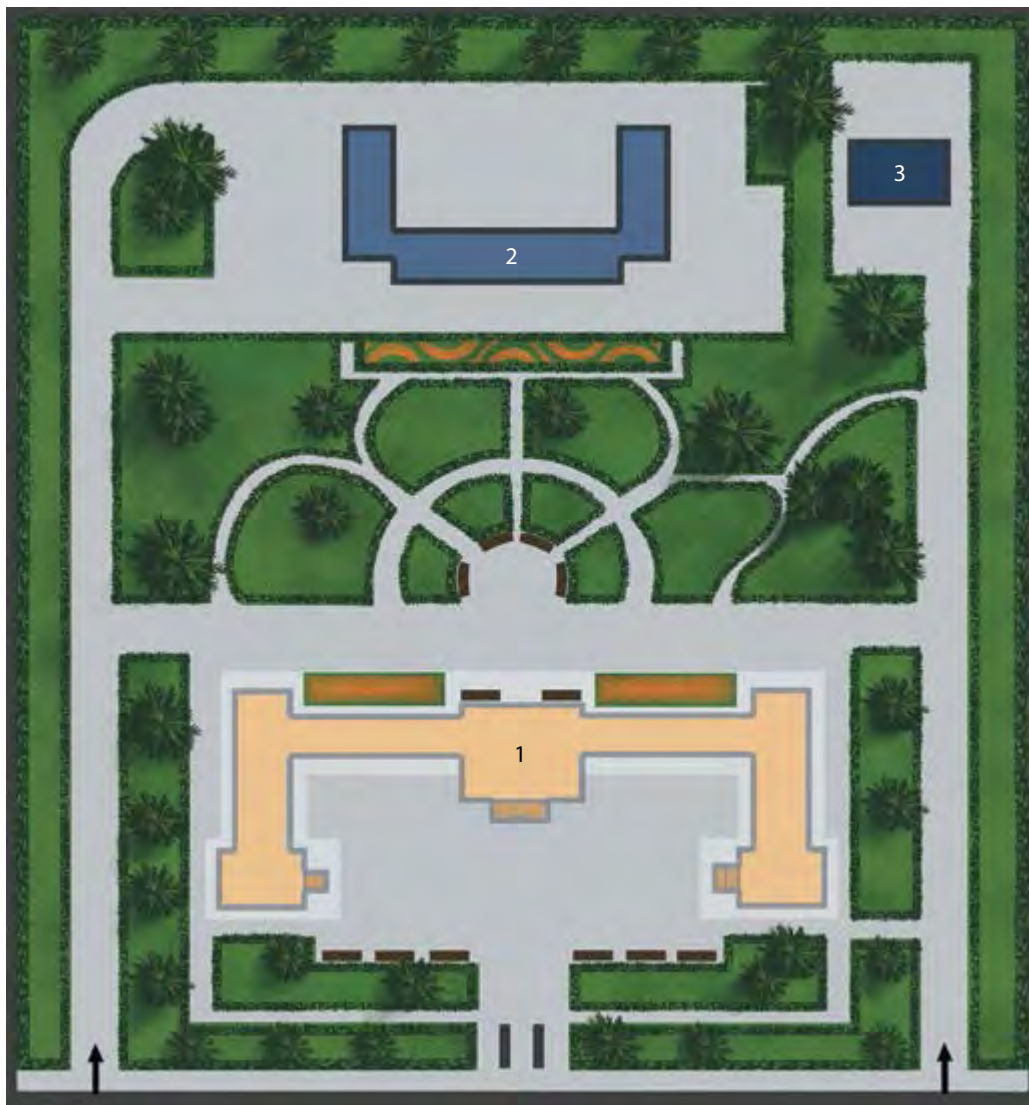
Генеральний план лікарні на 400 ліжок: 1 – головний корпус; 2 – господарчий корпус; 3 – патологоанатомічний корпус
